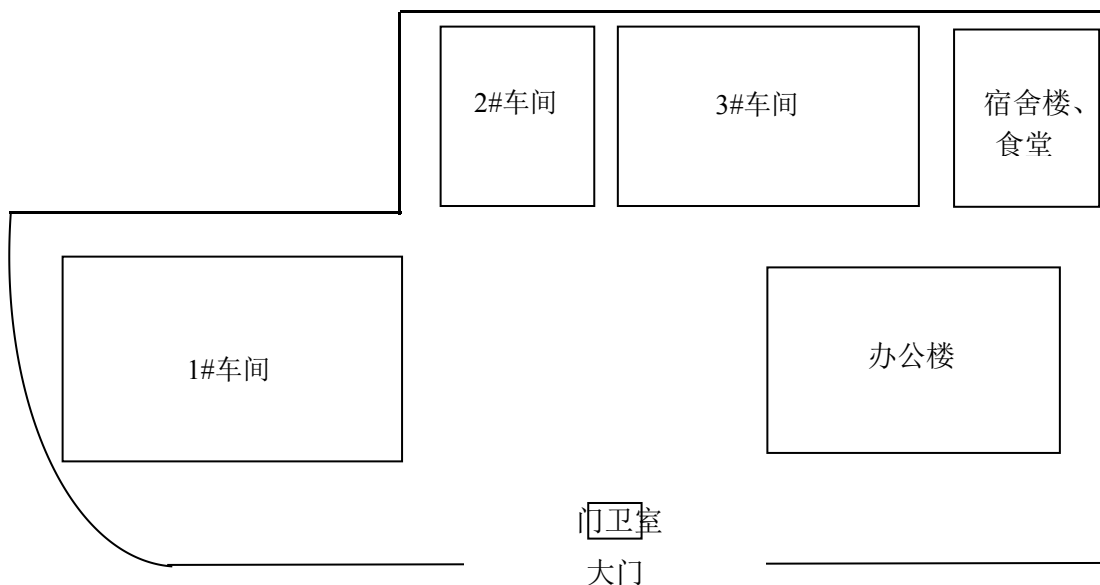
浙江晨泰科技股份有限公司厂区平面布置图
